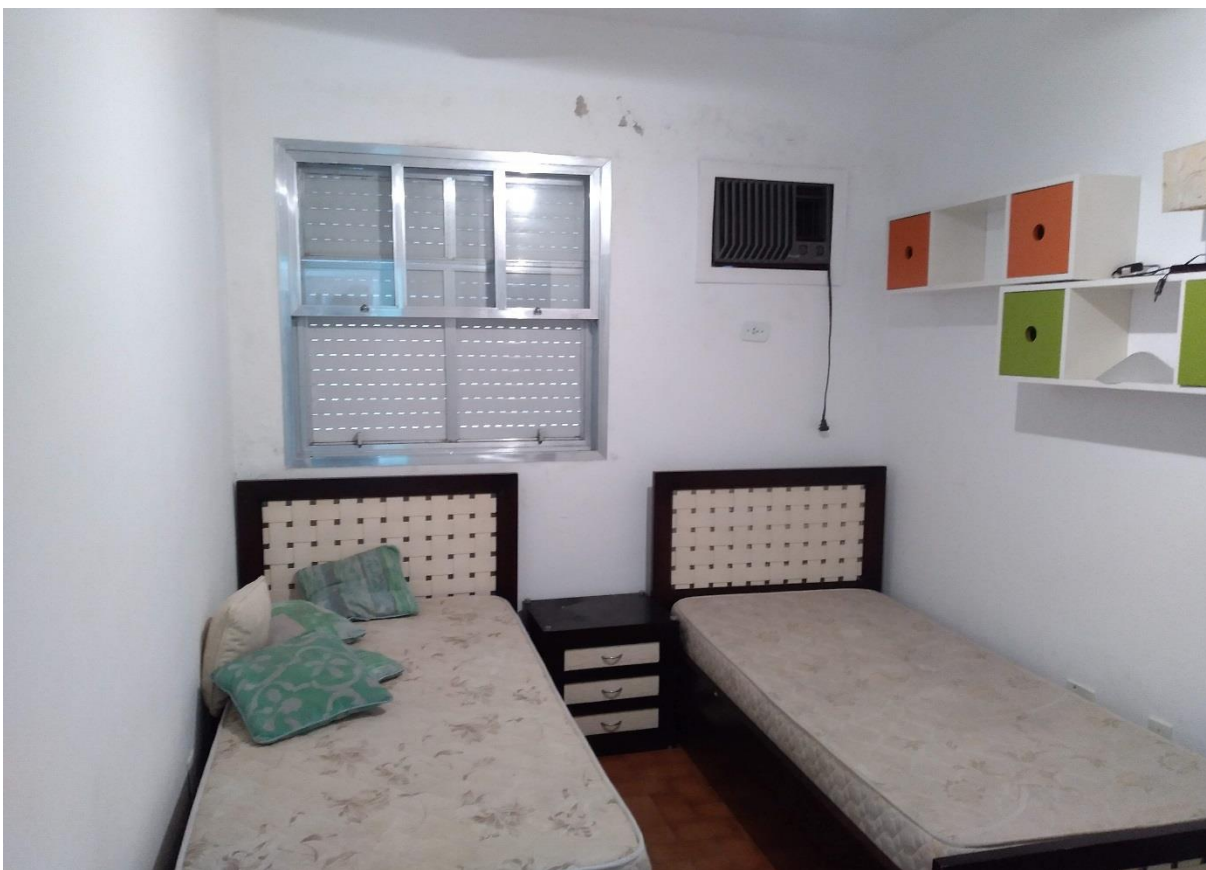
Vista parcial de outro dormitório com infiltrações nas paredes e tetos.
